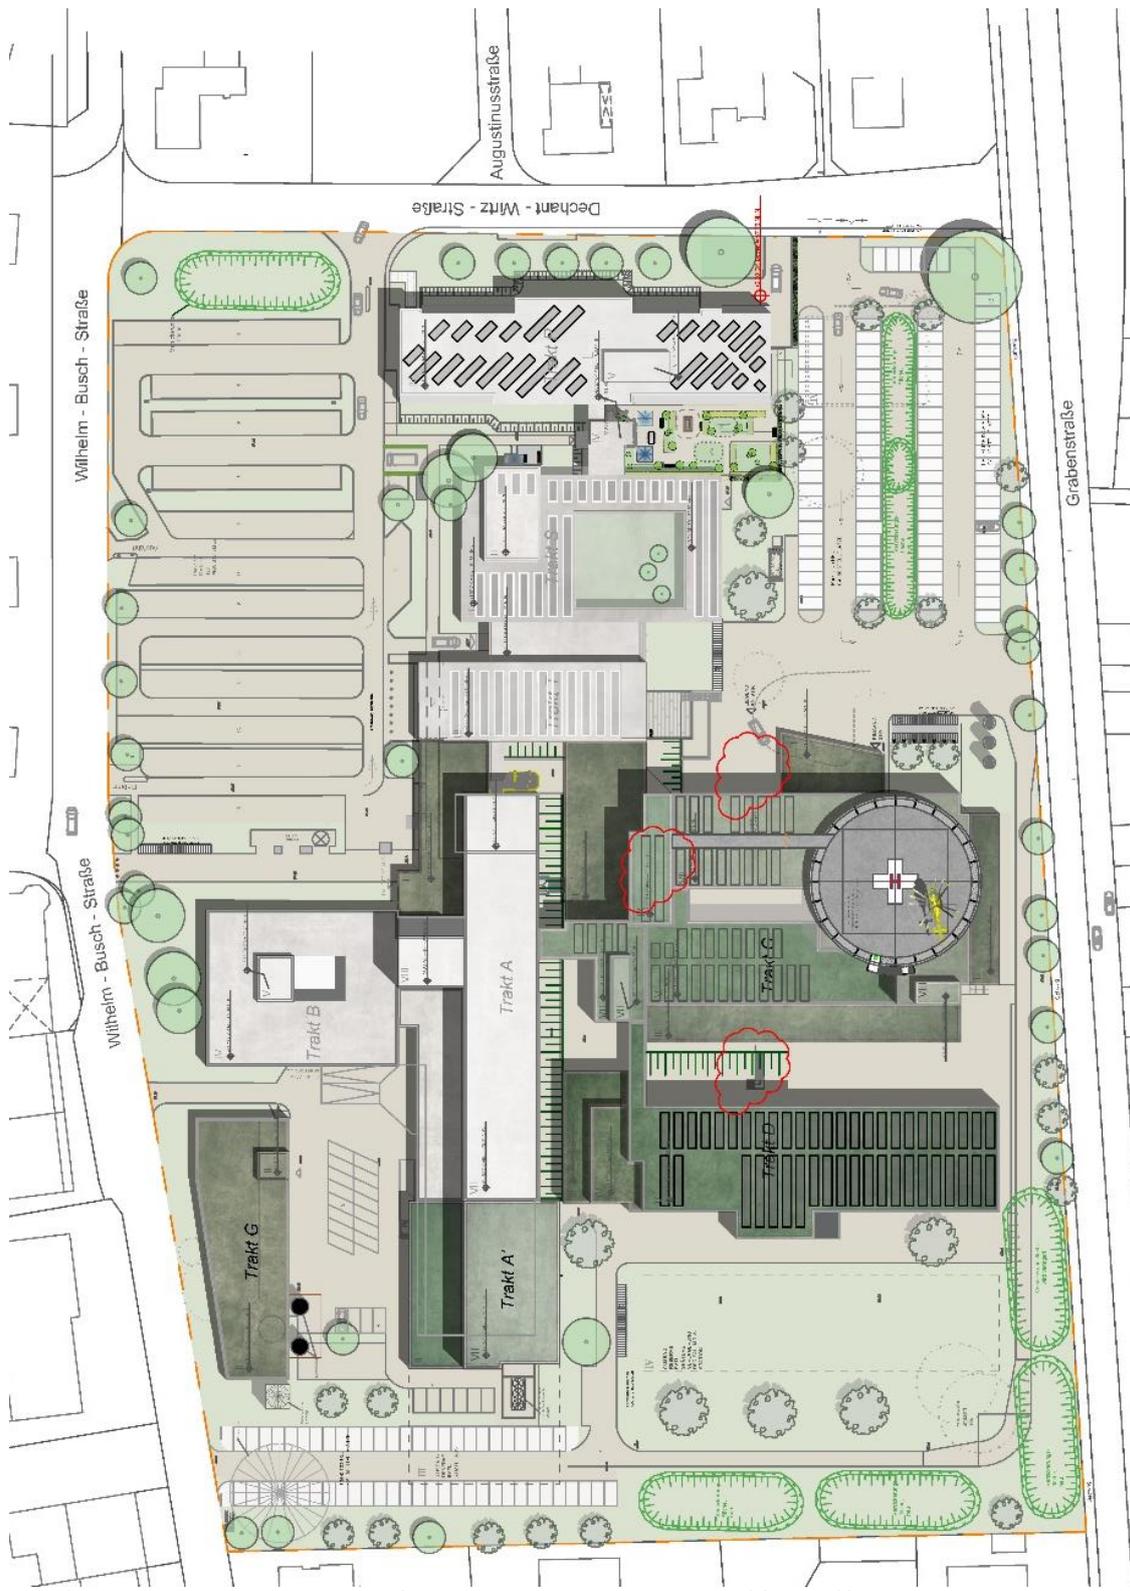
Lageplan Bauvorhaben St. Johannes Krankenhaus Troisdorf Sieglar (Quelle: Architekten Beckmann)
